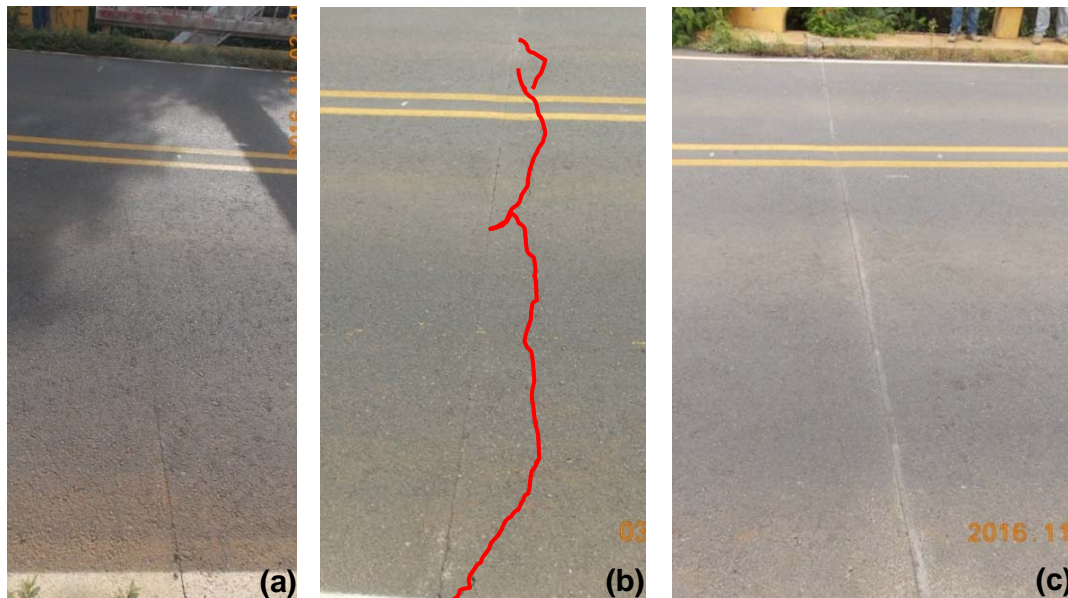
Juntas de expansión obstruidas: (a) Junta en bastión B1; (b) Junta en pila P1 con agrietamiento en superficie asfáltica; (c) Junta en bastión B2.
